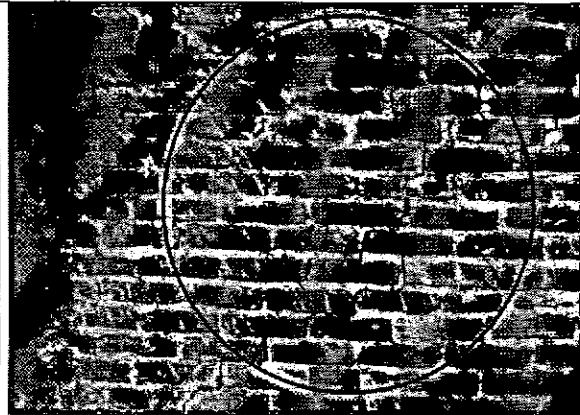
Agrietamiento en sector inferior del muro del costado oriental
